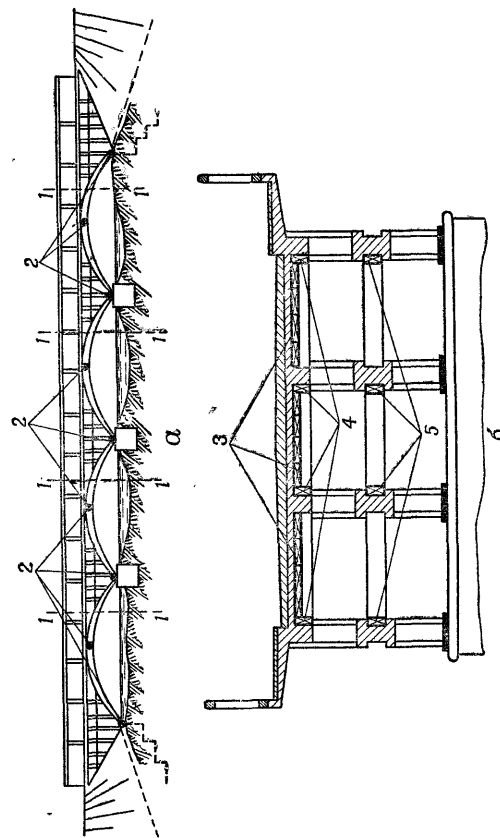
Подрывание железобетонного моста с пролетным строением на трехшарнирных арках: а — вид сбоку; б — поперечный разрез; 1—1 — сечения подрыва пролетного строения; 2 — шарниры; 3 — заряды на арках; 4 — заряды на продольных балках; 5 — заряды на арках
